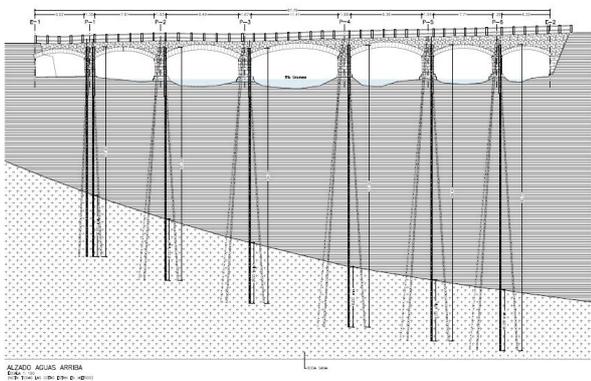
Plano del proyecto de recalce de la cimentación del Puente de Astiñene. Fuente: proyecto redactado por SESTRA.
